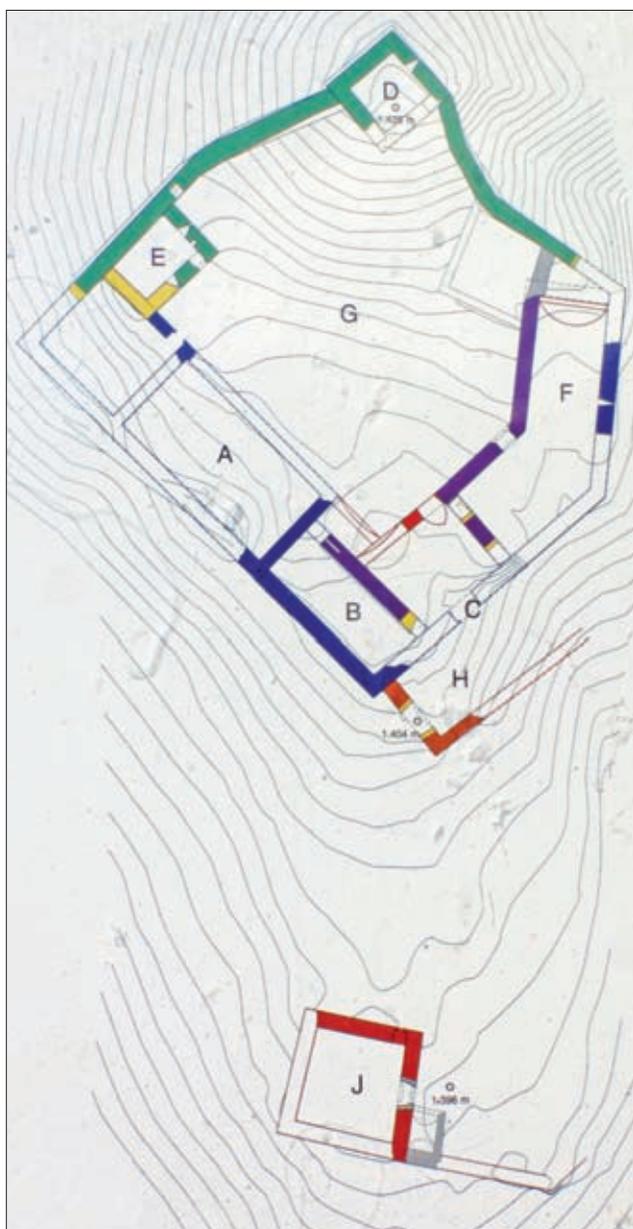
Nochmals der Grundriss, jetzt mit den Bauphasen
